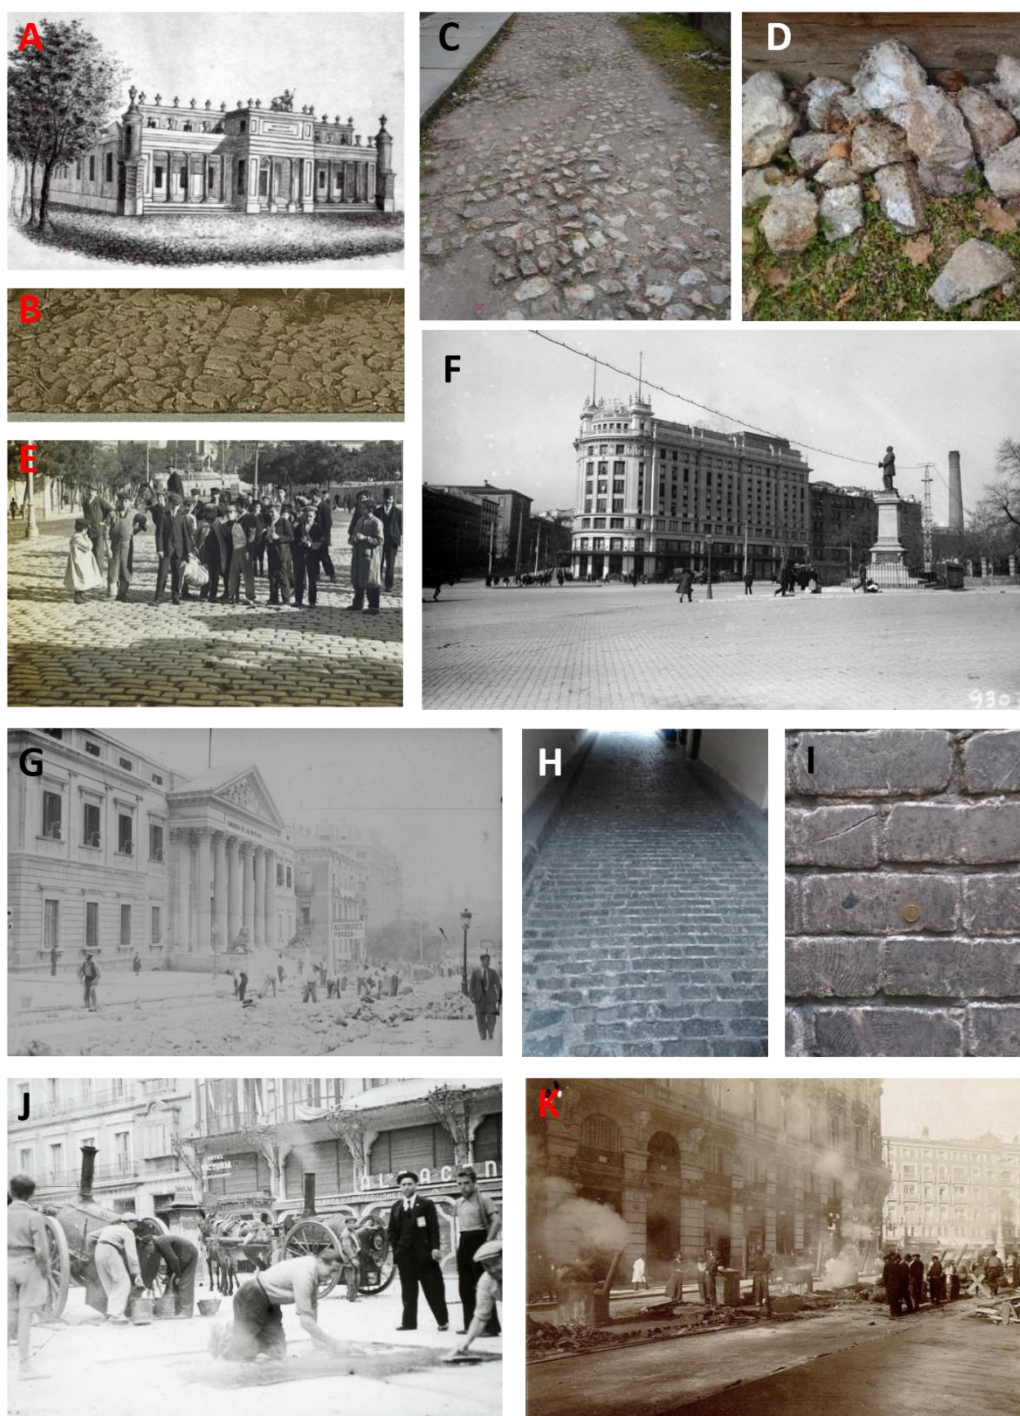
A: Pavimentación con morrillo, fábrica de la Platería de Martínez, actual hotel Saboy.
